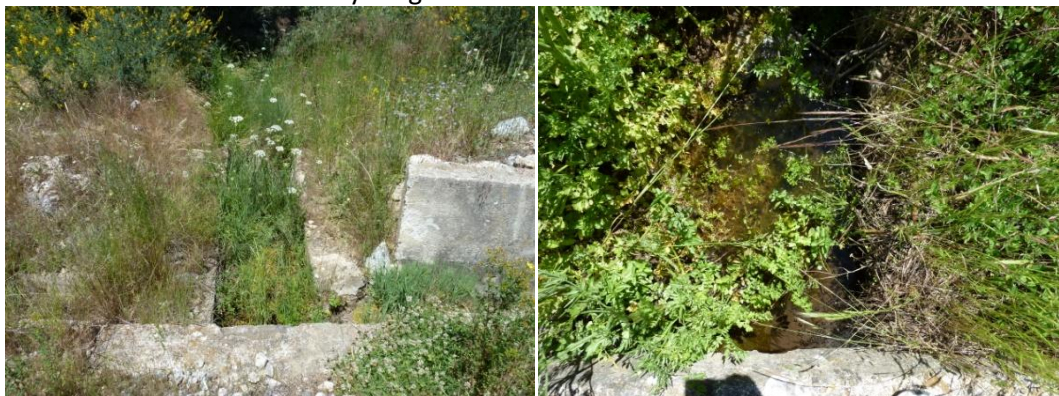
Estructura PK 80.40. Fuente: Elaboración propia.
